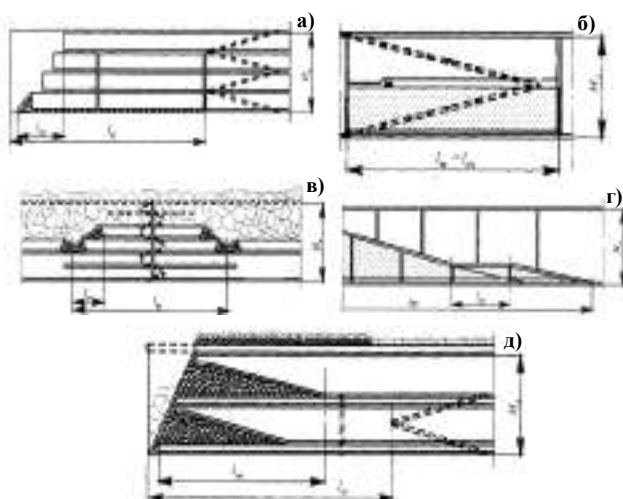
Варианты систем разработки. а - полевой уклон (система разработок подэтажными штреками); б - полевой уклон (система разработки горизонтальными слоями с закладкой); в - спиральный съезд (система разработки подэтажным обрушением); г - транспортный уклон в закладочном массиве; д - полевой уклон и слабонаклонная поверхность магазинированной руды (система разработки с временно неподвижной магазинированной рудой сплошной выемкой по простиранию)
